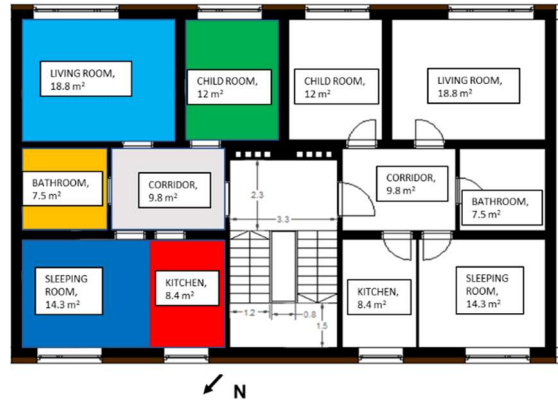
Grundriss des untersuchten Gebäudes mit der detailliert betrachteten Wohnung
